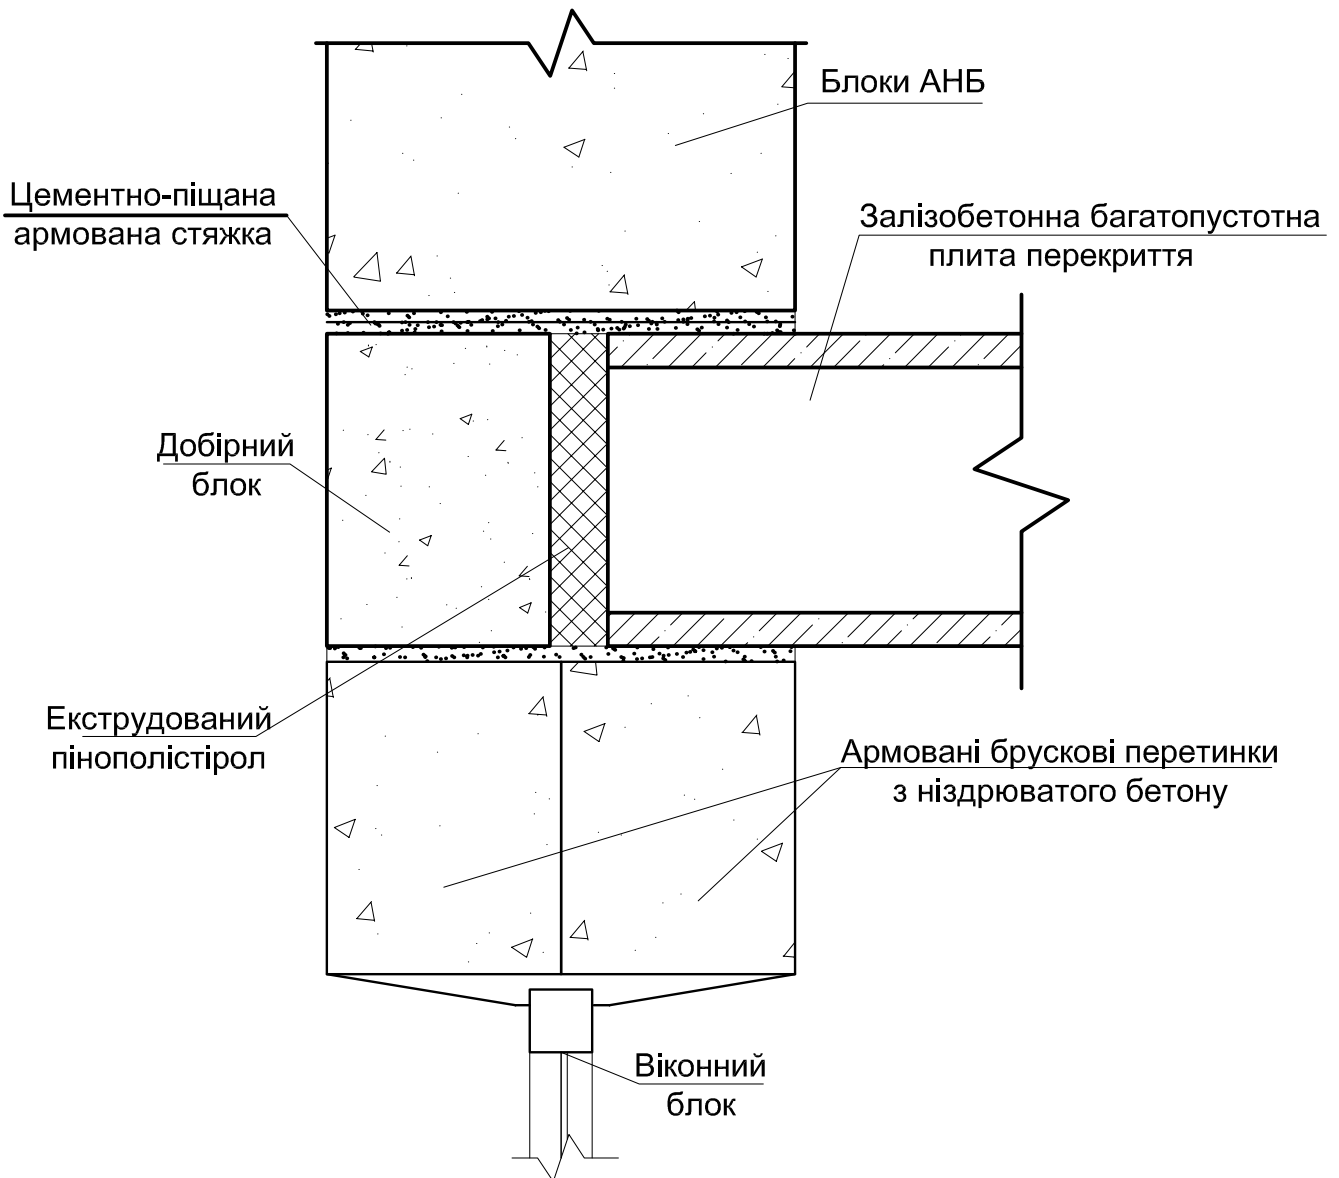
3. Армовані перемички з ніздрюватого бетону
